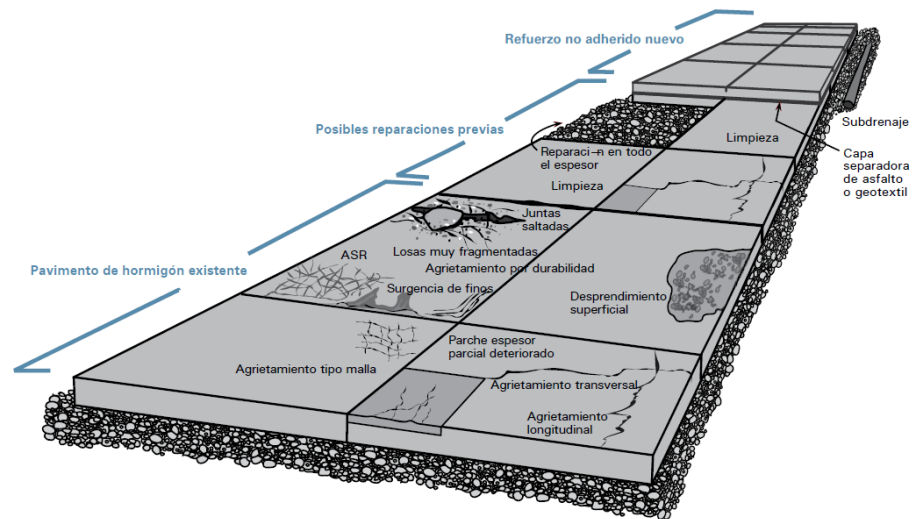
Whitetopping no adherido para un pavimento rígido en malas a deterioradas condiciones.
